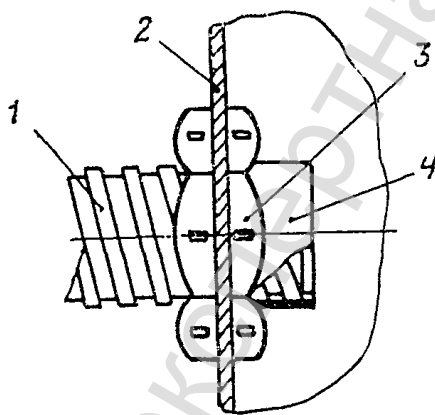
Крепление металлорукава к корпусу клеммной и протяжной коробок на гайках:
